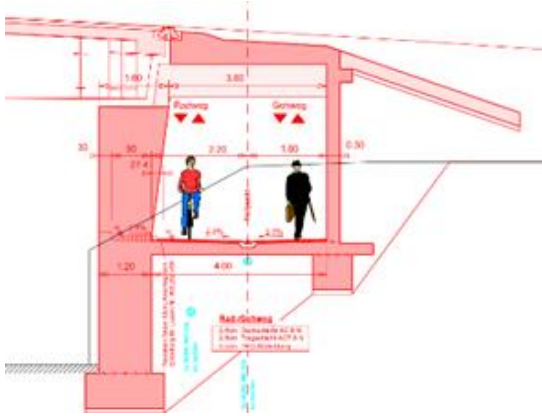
Bestehender Durchgang unter Langensandbrücke
